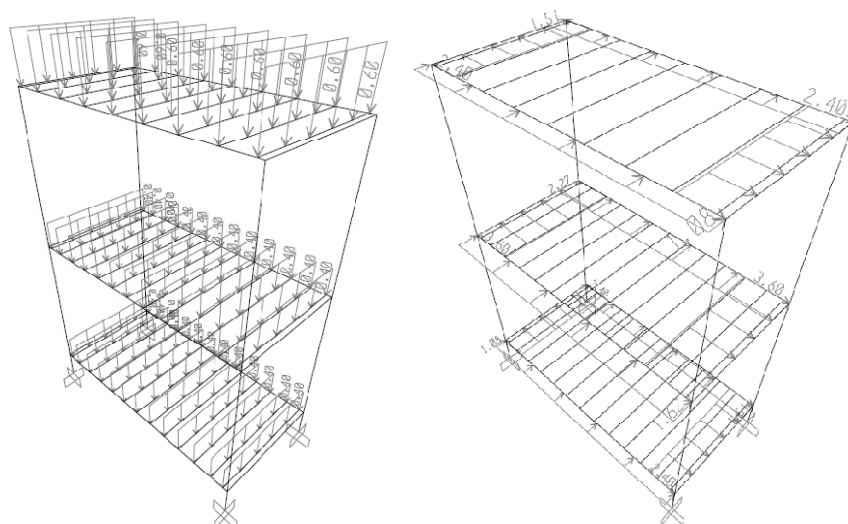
Aplicação das cargas horizontais e verticais no SAP2000
